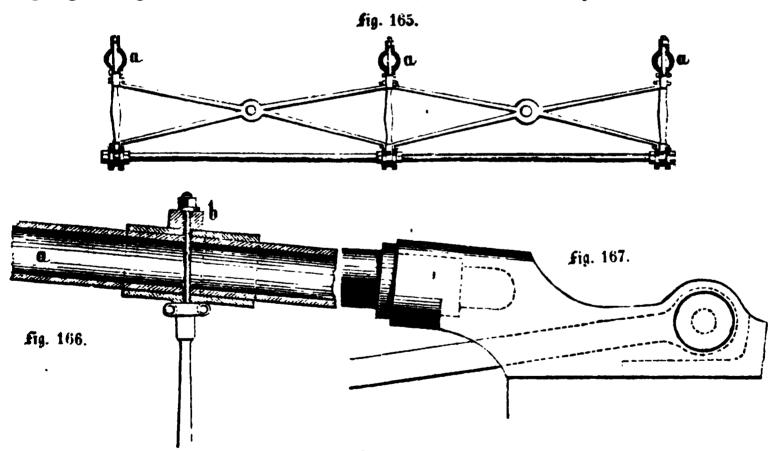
bis 167. Details zur fußbrücke über den Stadtkanal zu Potsdam.
